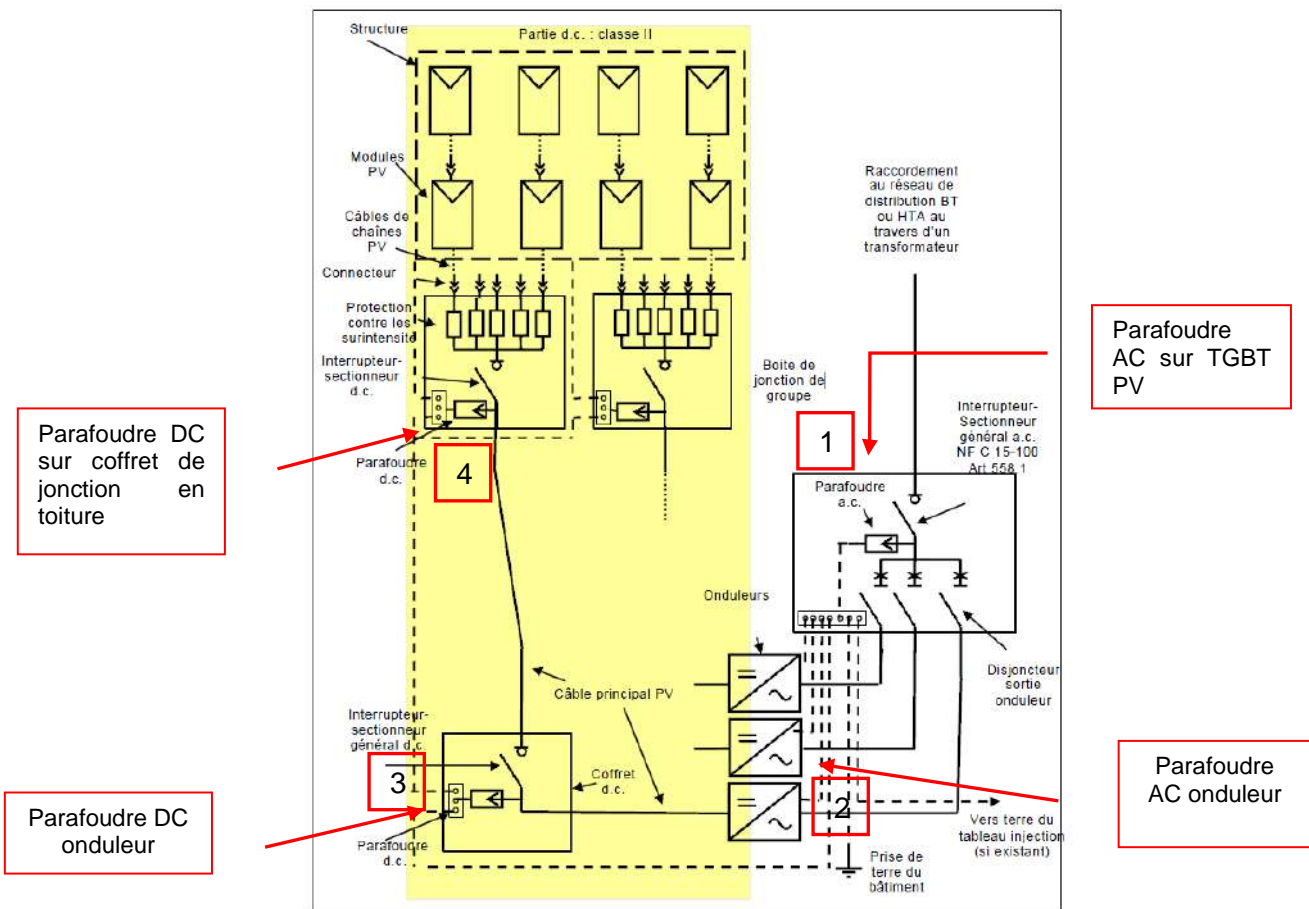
Implantation des parafoudres sur l'installation PV. (UTE 15-712)
